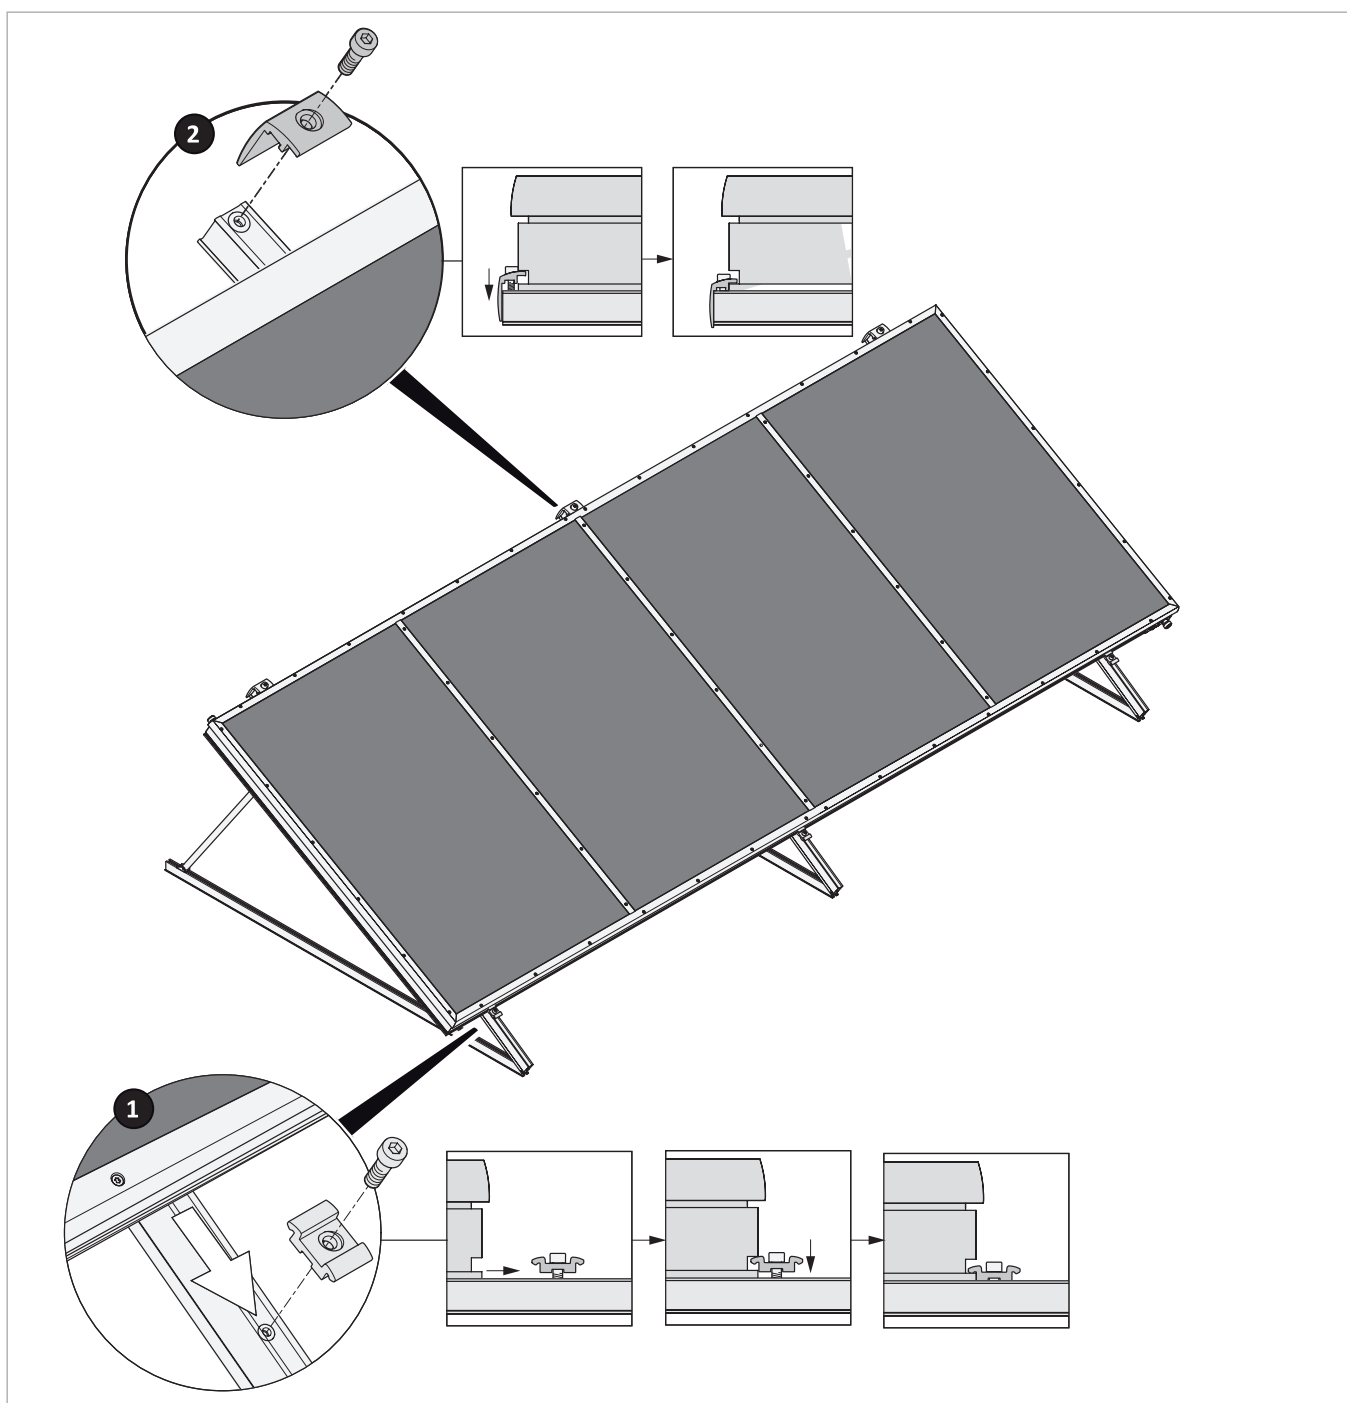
fissaggio di un collettore su supporti per tetto piano
